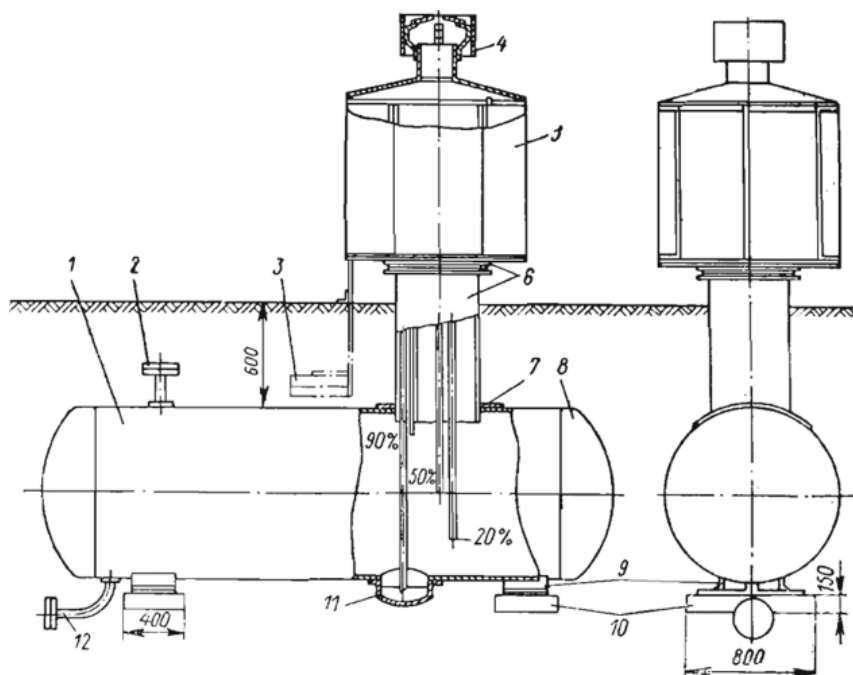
Подземный резервуар для хранения сжиженного газа: 1 – цилиндрическая часть; 2 – патрубок паровой фазы; 3 – опорные плиты для крепления защитного кожуха; 4 – дефлектор; 5 – защитный кожух; 6 – горловина; 7 – воротник для усиления сварного шва; 8 – сферическое днище; 9 – опоры; 10 – фундамент; 11 – отстойник; 12 – патрубок жидкой фазы
